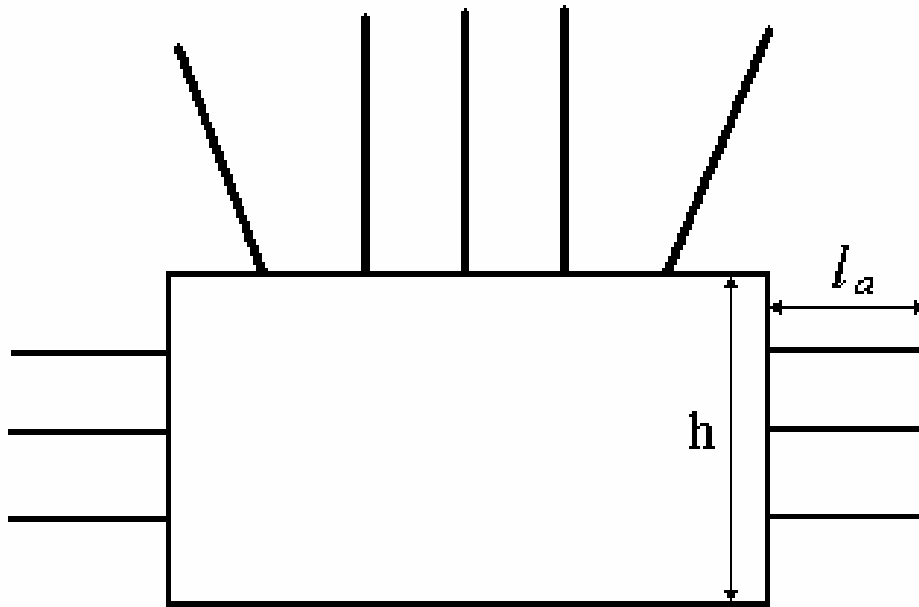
Схема расположения анкеров в кровле и боках подготовительной выработки
